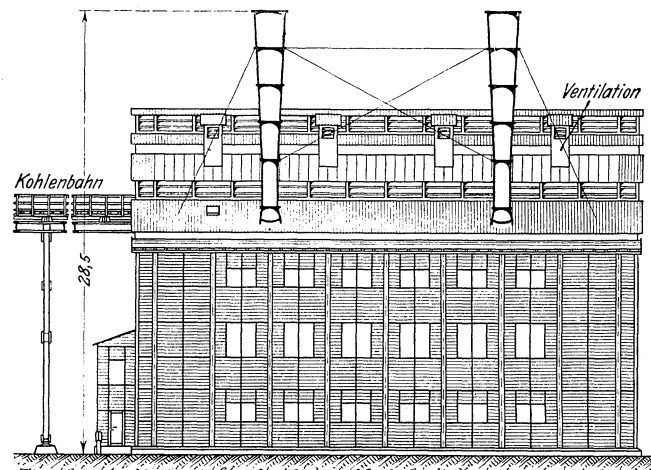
Querschnitt des Maschinen- und Kesselhauses.
